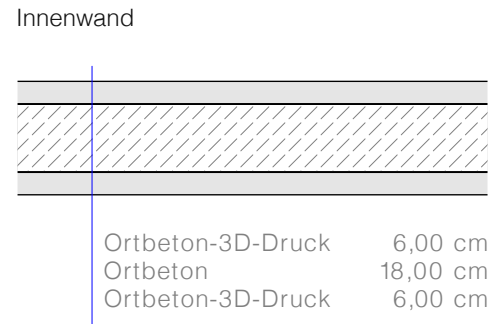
EFH Wandaufbau Innenwand | M 1.20
